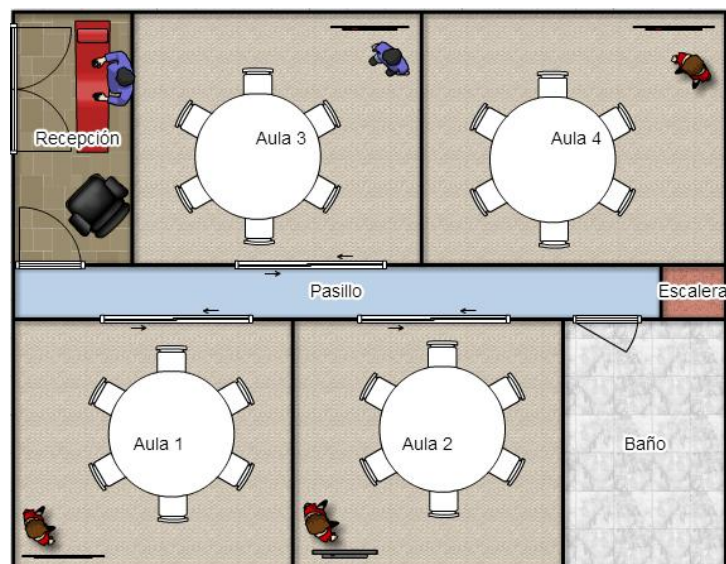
Plano de la distribución de la planta baja del establecimiento. Fuente: Elaboración propia.
